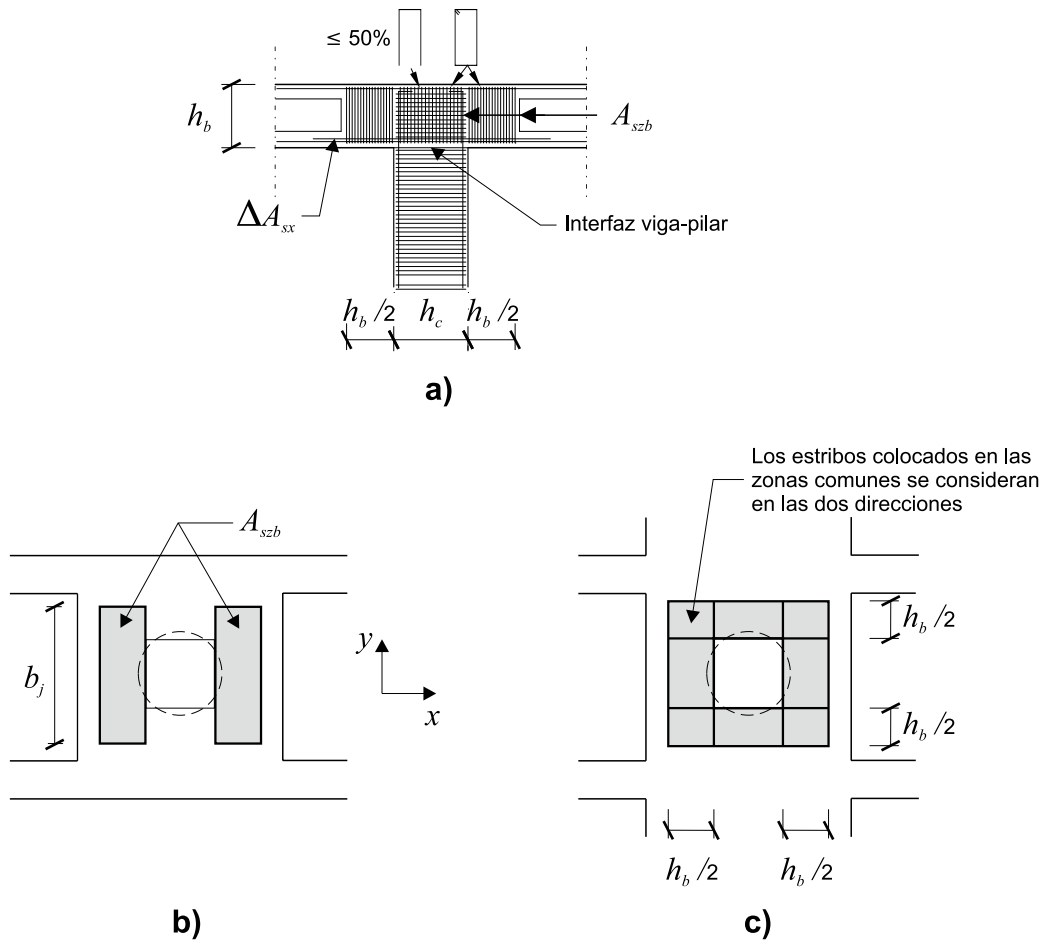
Disposiciones alternativas de las armaduras de los nudos; (a) sección vertical en el plano xz ; (b) vista en planta de las rótulas plásticas formadas en la dirección x ; (c) vista en planta de las rótulas plásticas en las direcciones x e y (Figura 5.4 de UNE-EN 1998-2)
